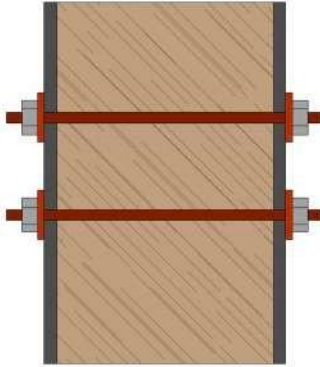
Pletinas de acero en laterales viga. Fuente propia
